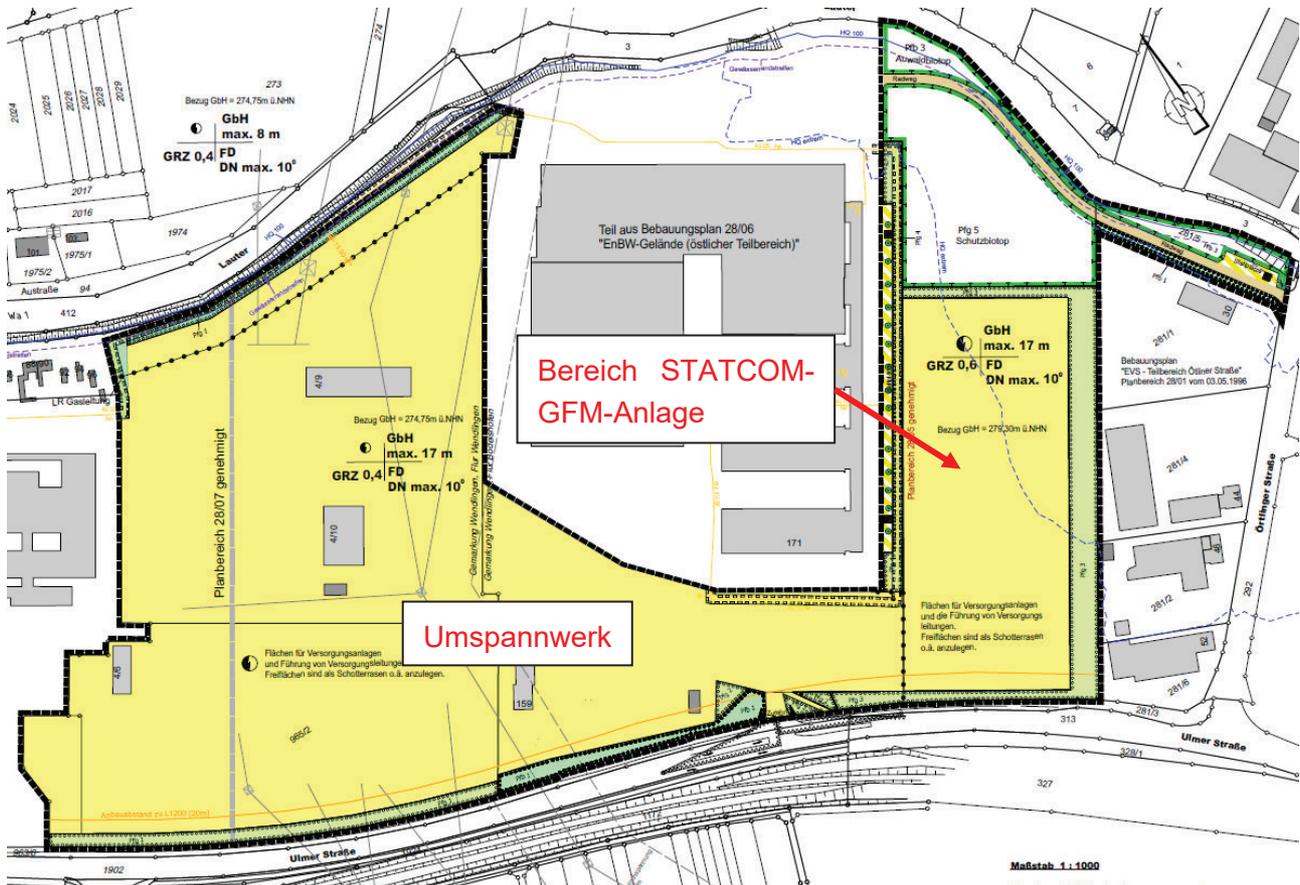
Entwurf des Bebauungsplans als Bilanzierungsgrundlage (MESSMER CONSULT 2023)
